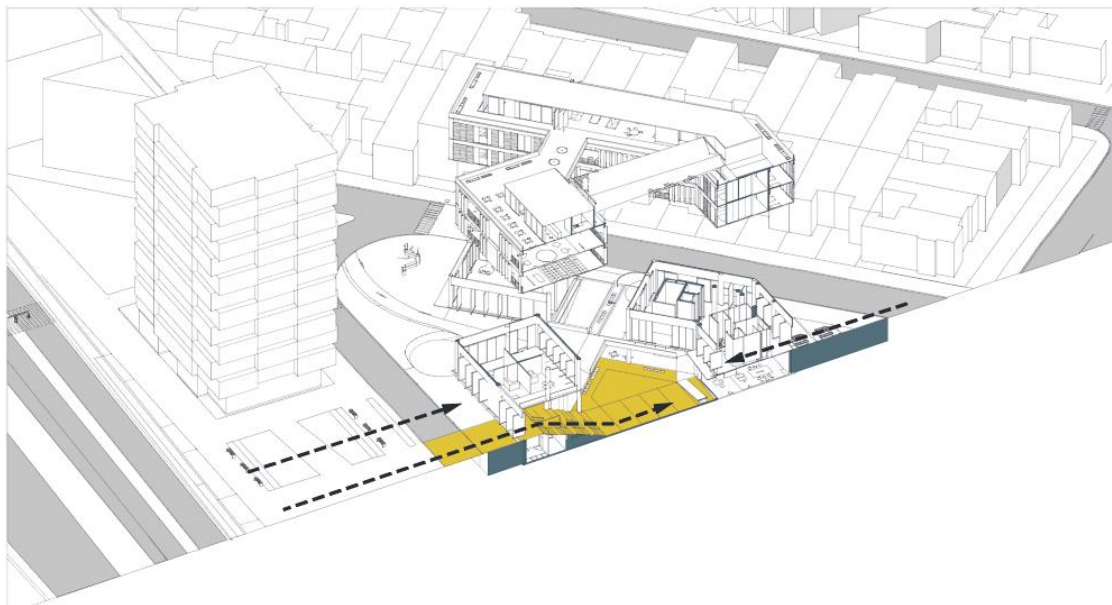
Liberación de planta baja. (Villegas, C. 2021)
